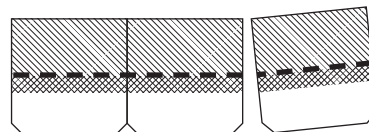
Les bardeaux Shadow Ridge se détachent facilement de la bande de trois pièces pour former 72 pièces de couronnement individuelles.
